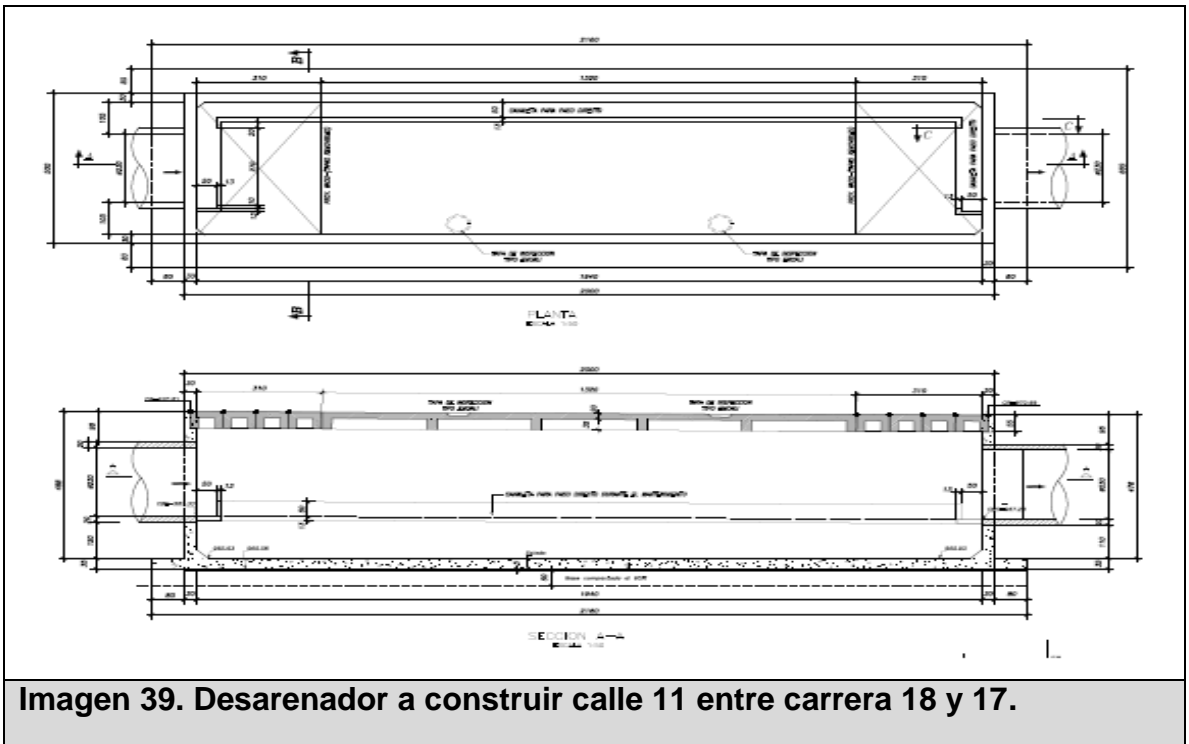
Desarenador a construir calle 11 entre carrera 18 y 17.
